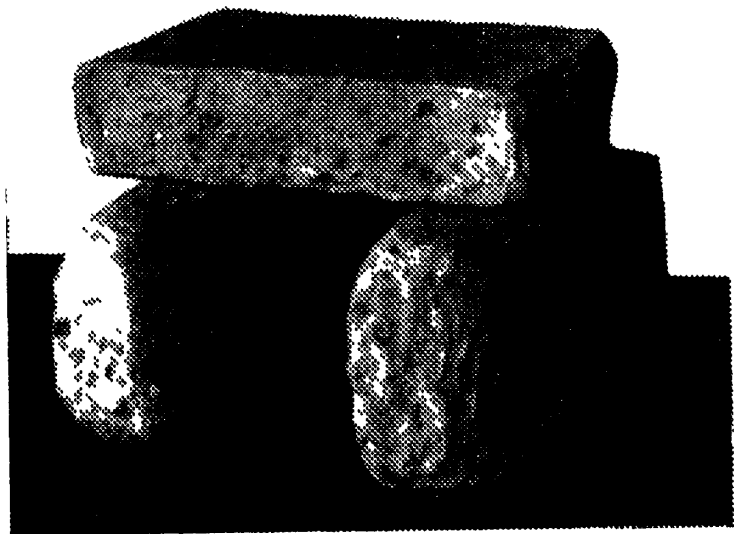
Разрушенный силикатный кирпич, отобранный из кладки стен
